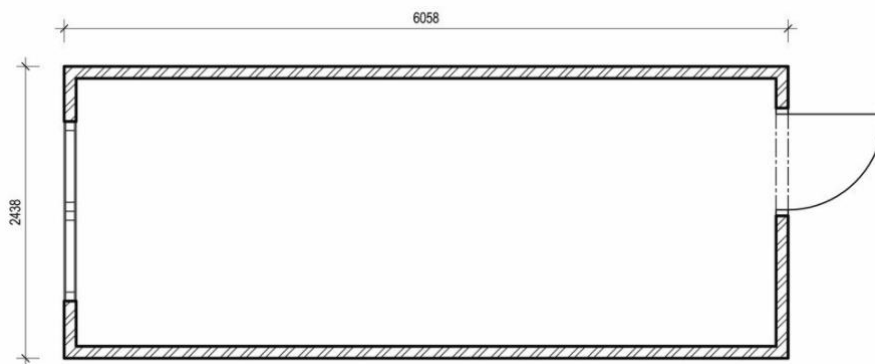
Půdorys skladovacího kontejneru Toi Toi LK1 [11]
